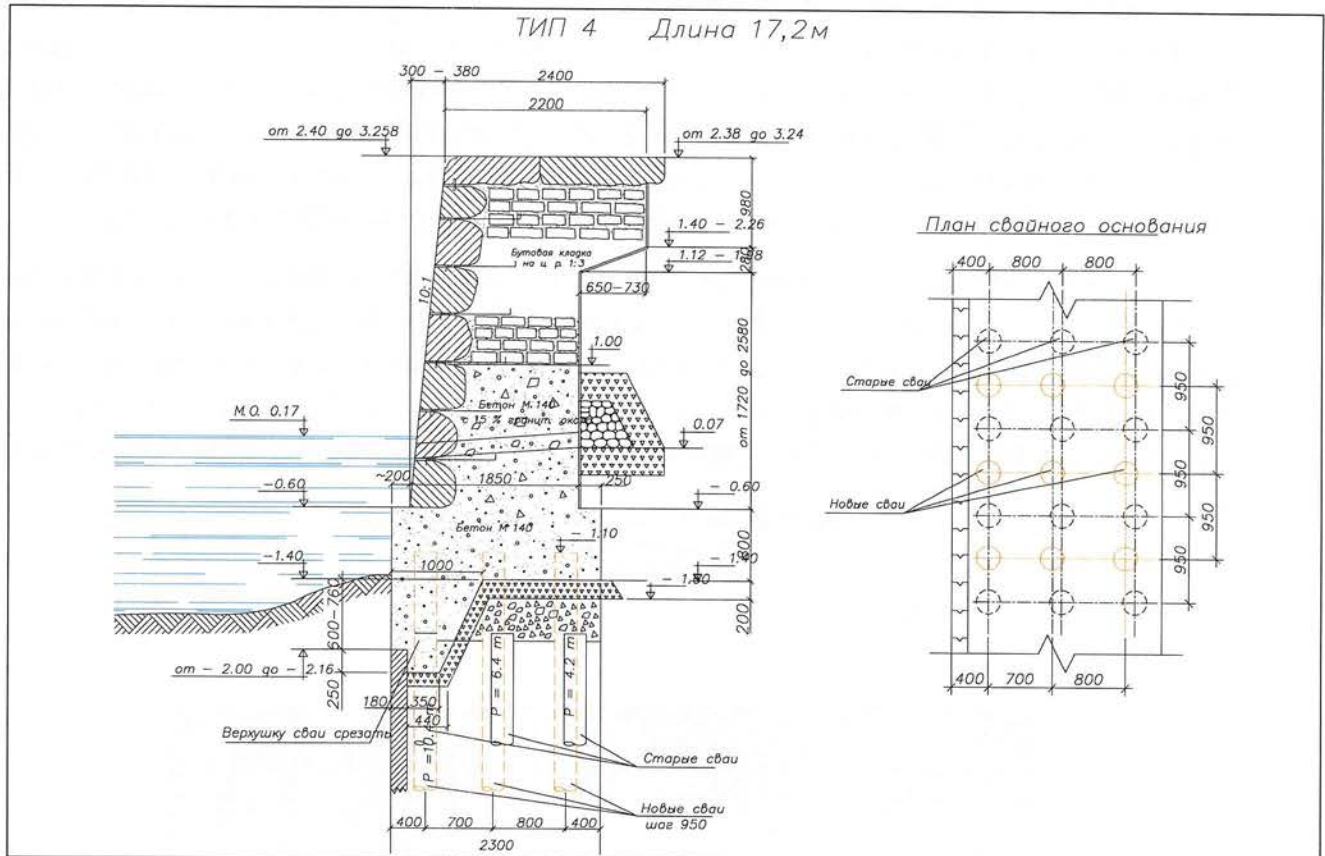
Поперечное сечение стенки набережной тип 4 у Матвеева моста
